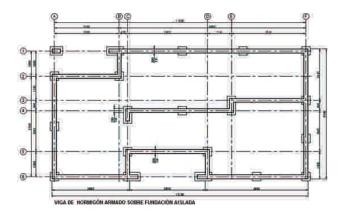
37 : Plano de fundación aislada con viga de hormigón armado, donde se especifican los ejes que es necesario replantear para los cimientos aislados.
